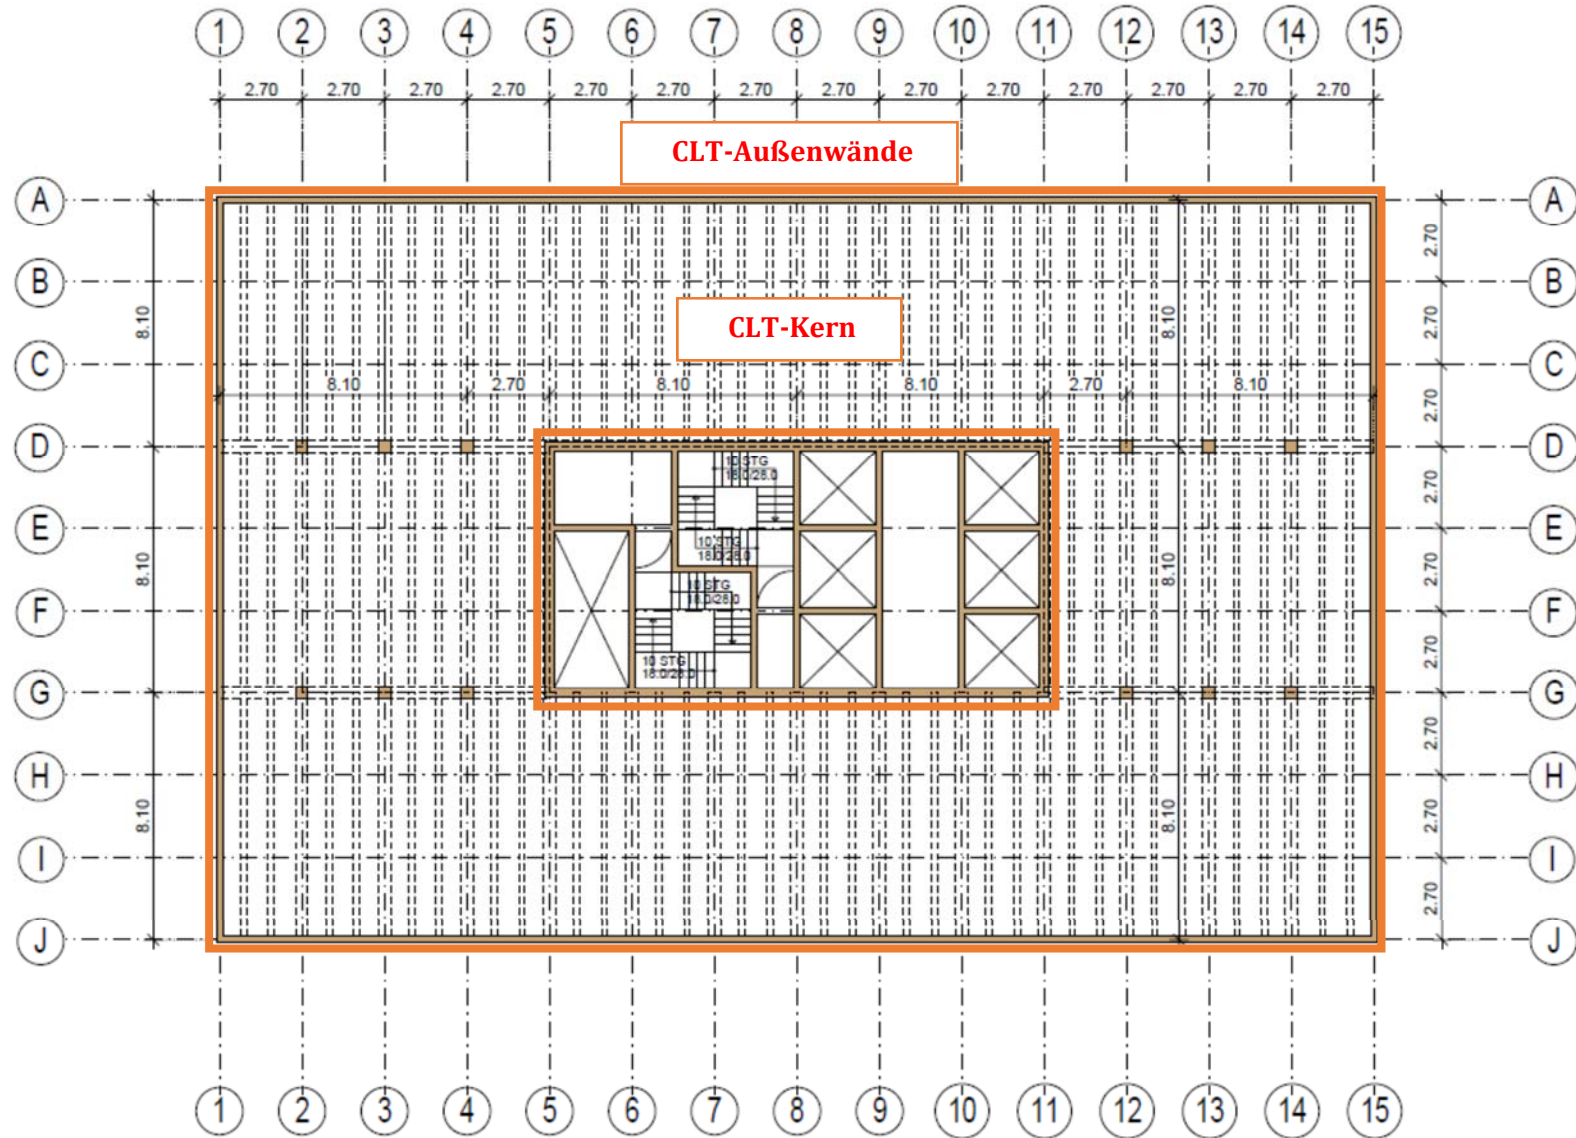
Grundriss Tragwerkstyp 4
